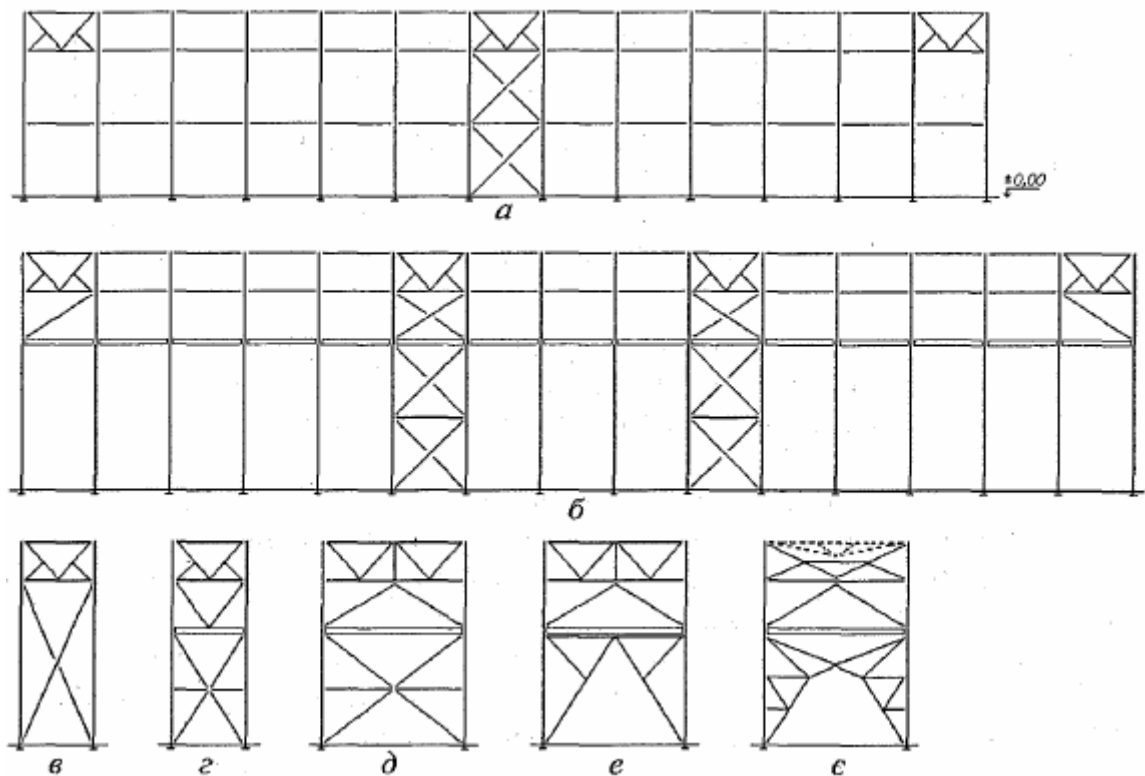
Схема вертикальних в'язей по колонам: а – у безкранових каркасах і з підвісними кранами; б – з мостовими кранами; в,г,д,е,є – схеми в'язей
